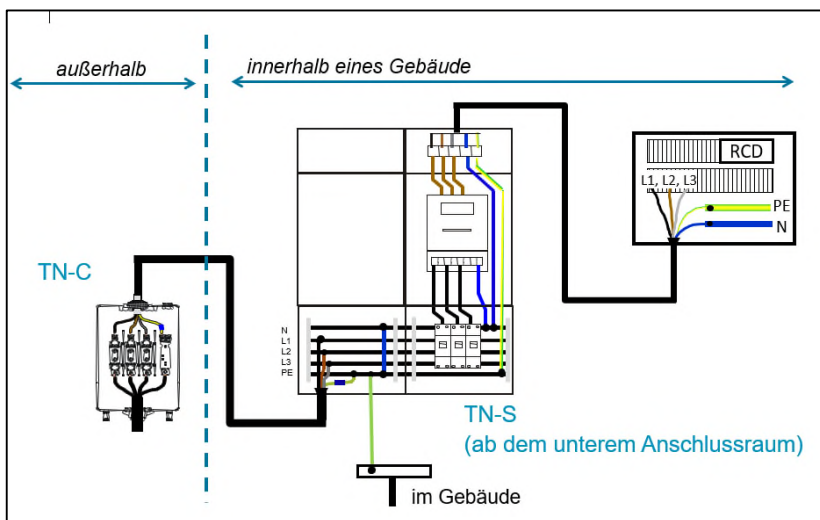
TN-C-S-System – Netzanschluss befindet nicht im Gebäude (z. B. Hausanschlusssäule, Zähleranschlussssäule, Netzanschluss in der Außenwand und auch bei Dachständeranschluss)
